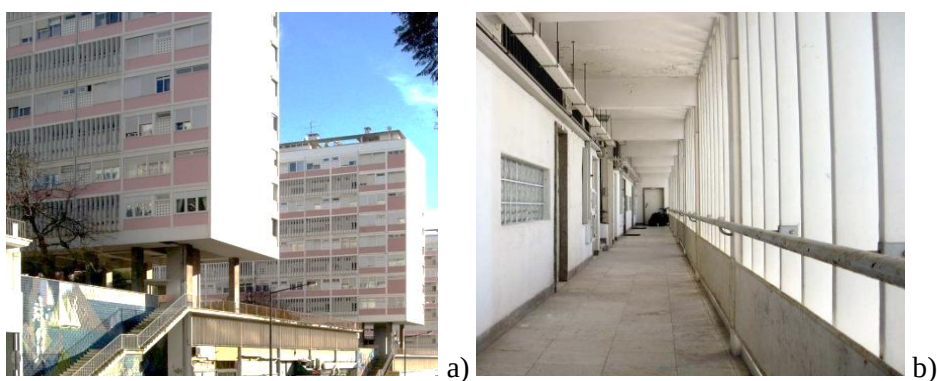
Fotografias do caso de estudo: a) Pormenor das fachadas (Rocha, 2012); b) Pormenor da galeria de serviço com grelhas verticais em betão (Silva, 2015).
